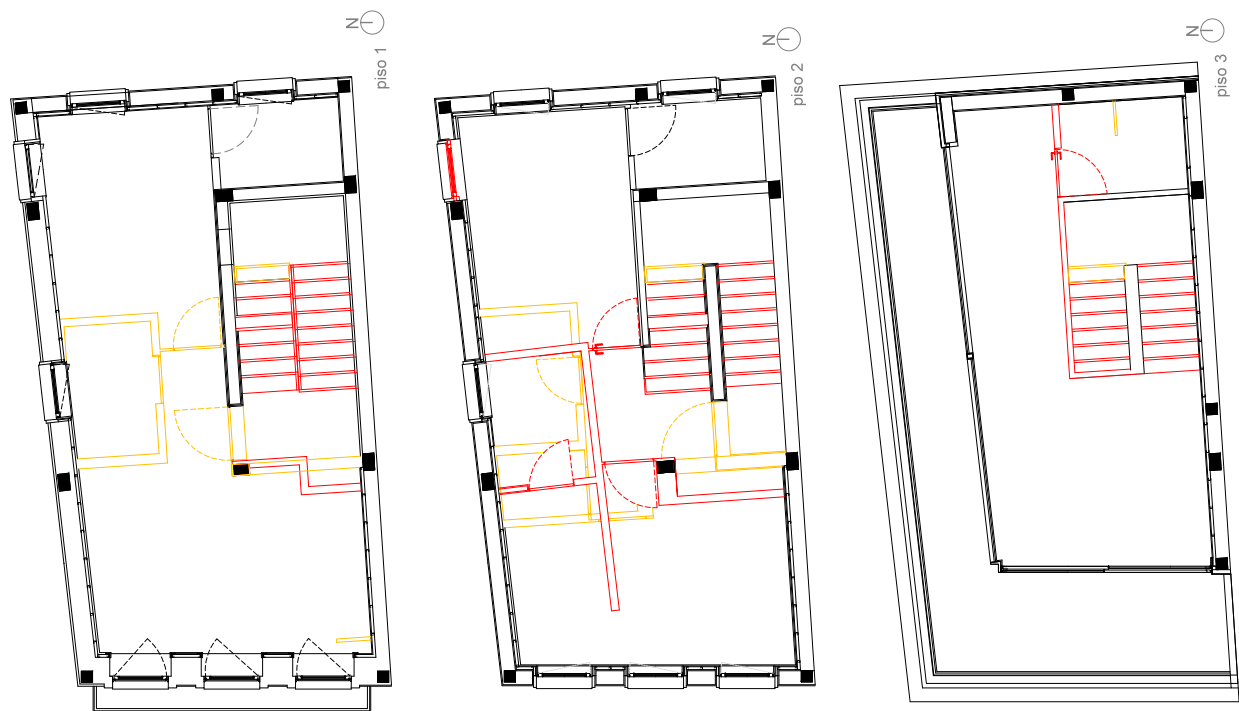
Planta de alterações piso 1, 2 e 3. Fonte: Autores
